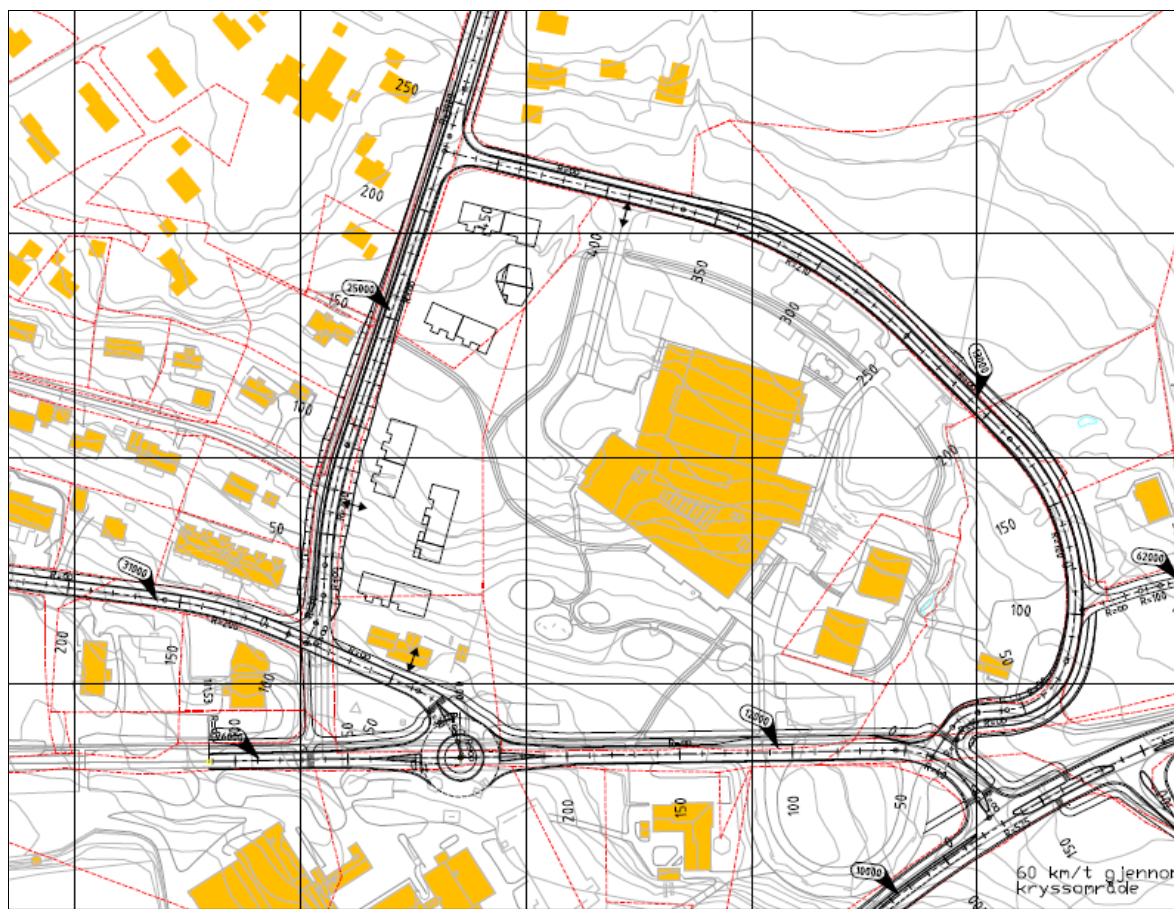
Illustrasjonsplan Nedre Prestdalsvei (Arkiplan/Asplan Viak 10.02.2014)
